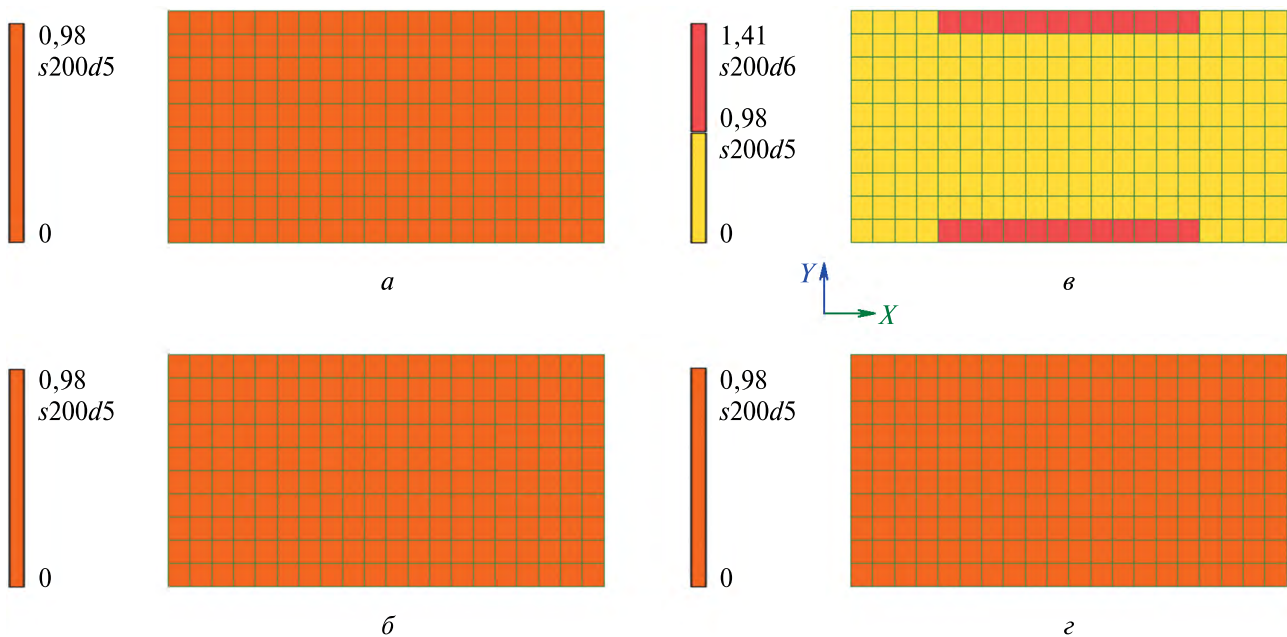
Армирование плиты перекрытия при использовании бетона класса В15 или В35 и арматуры класса А400:
